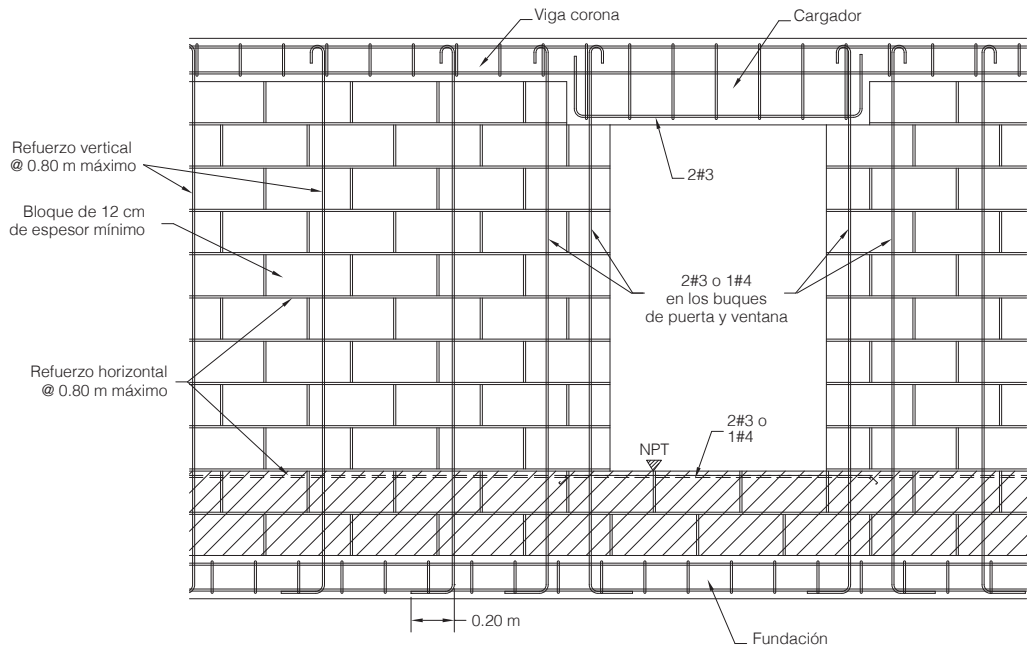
Elevación de pared de mampostería con refuerzo integral.
